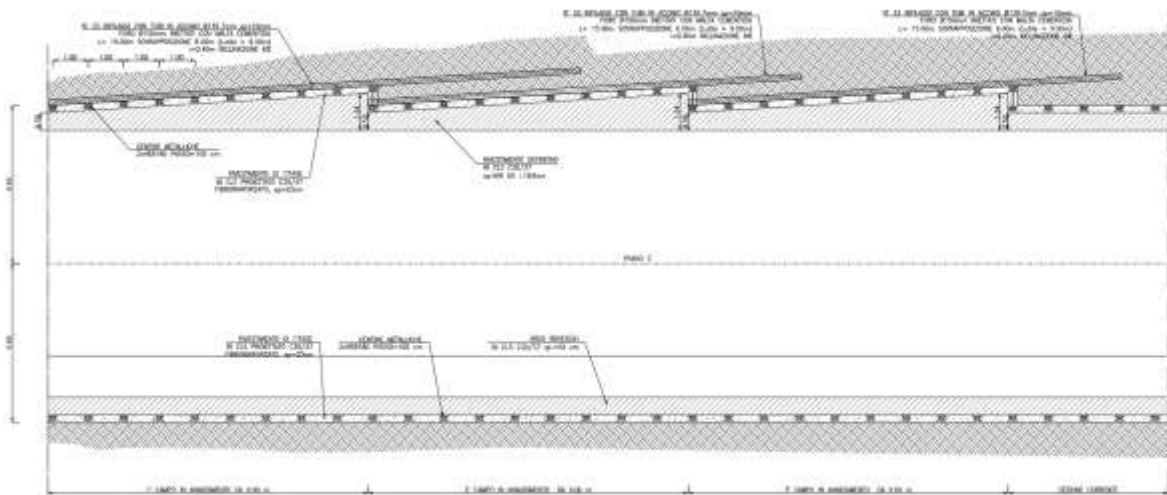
Sezione tipo Sf-imb: geometria del cavo e interventi di sostegno, sezione longitudinale
